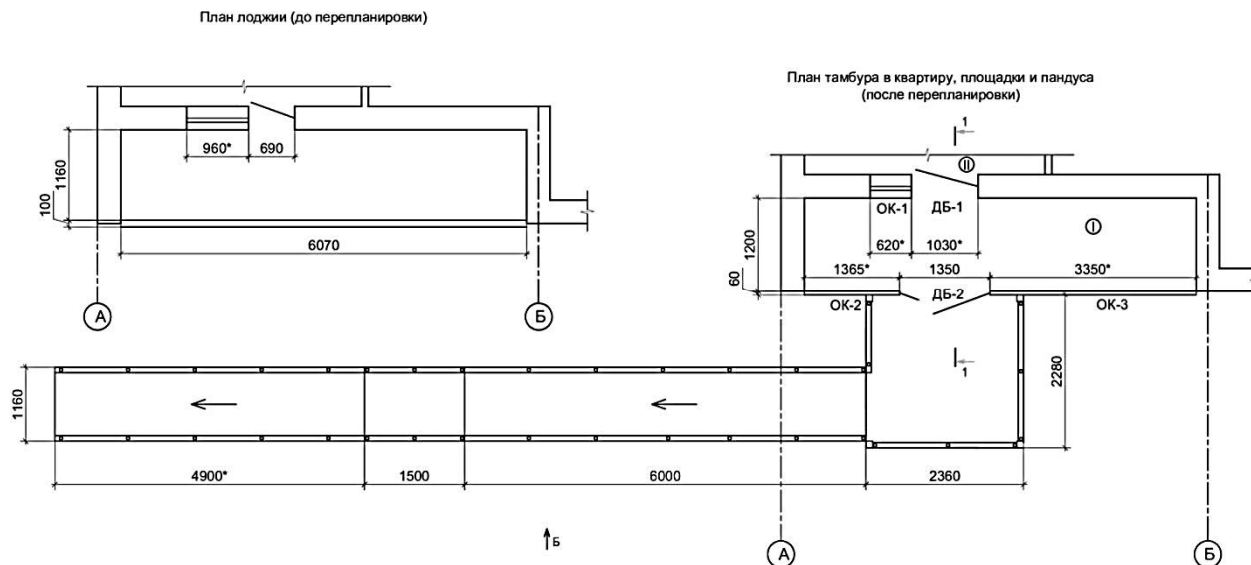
Проектное предложение по реконструкции входной группы многоквартирного жилого дома №16 по ул. Старых большевиков, г. Воронеж (План до и после перепланировки)
